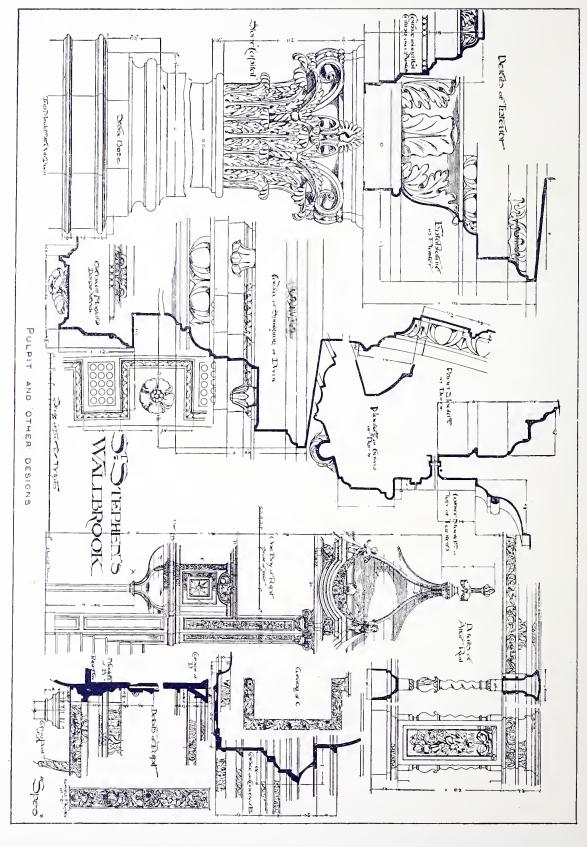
und 439. Kirche von St. Stephen's Wallbrook (n. Building News).
